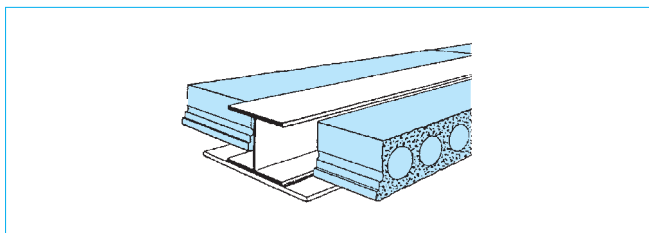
Dalle alvéolée précontrainte intégrée à une poutre en acier
